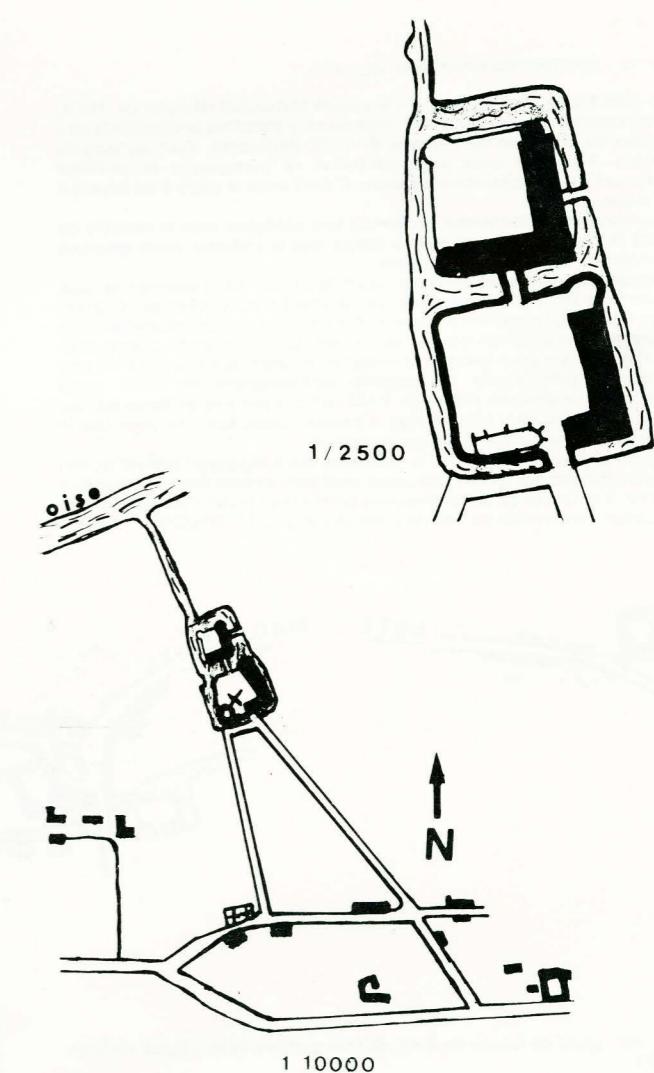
plan de masse de Béthancourt-en-Valois, 1828.
